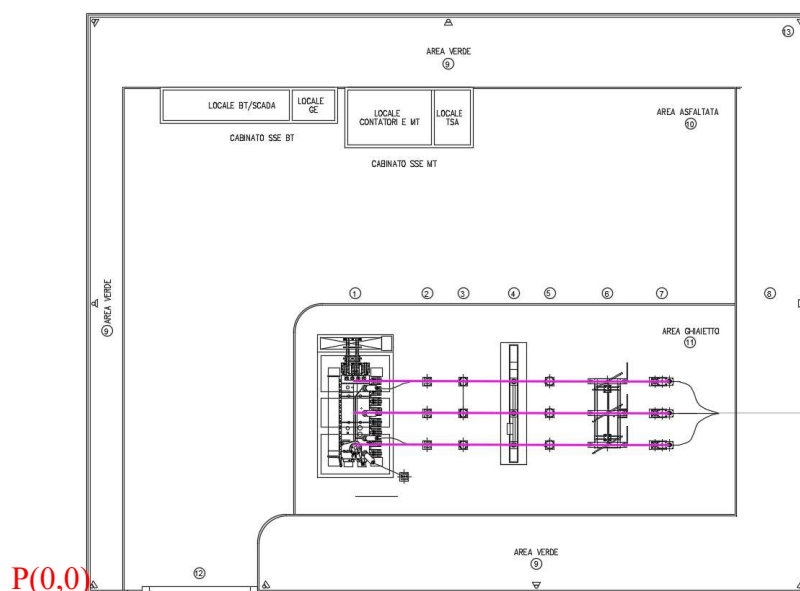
Planimetria della SSE di utenza di Morlenzo con individuazione degli elementi attivi
